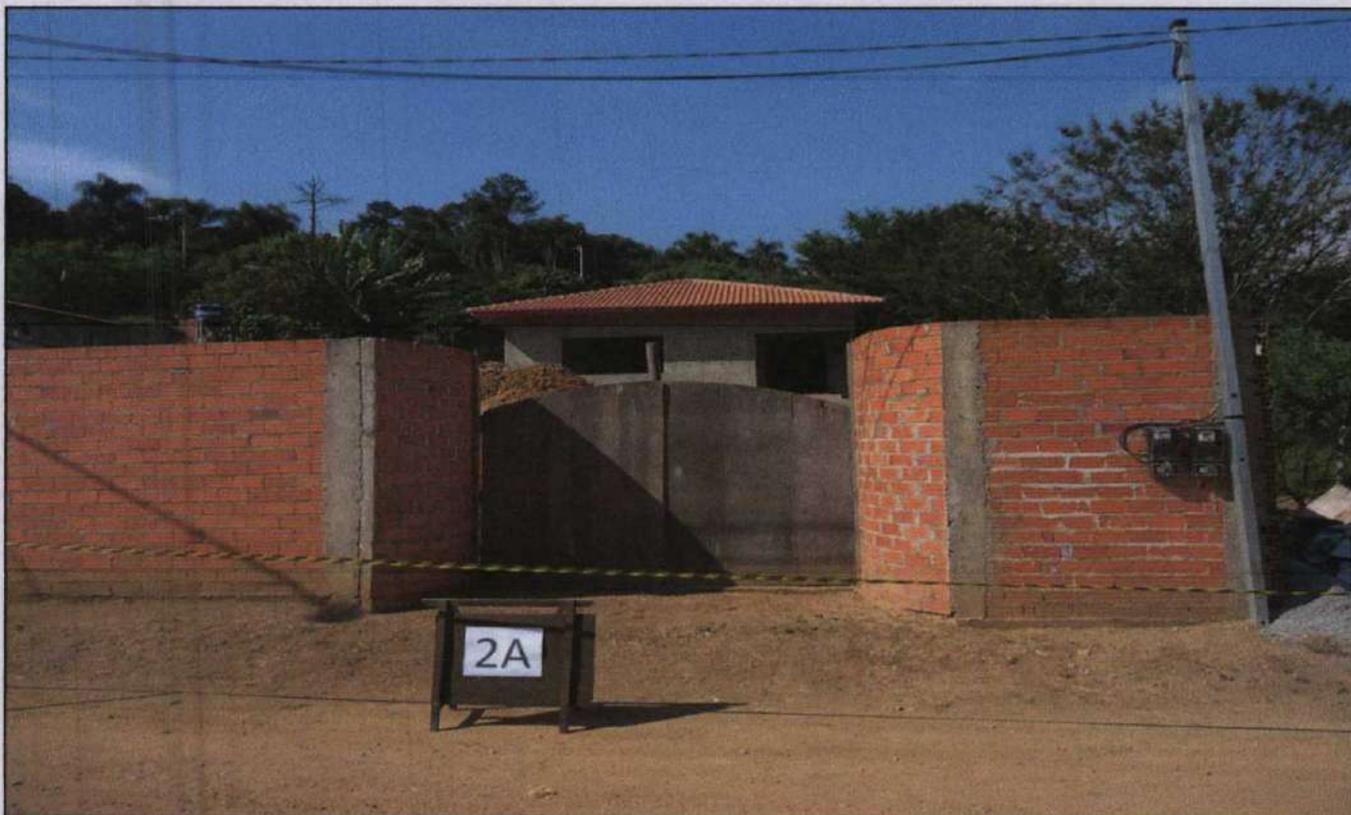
Lote 2A da rua Pindorama nº 1770, com construção inacabada.
